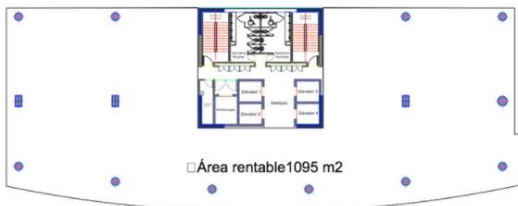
Planta arquitectónica tipo torre de oficinas Sania
